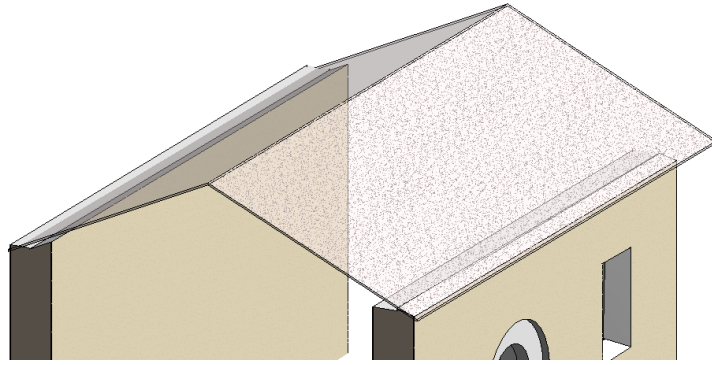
Creación de la cubierta de 3cm para colocación de las tablazones. Fuente: elaboración propia
